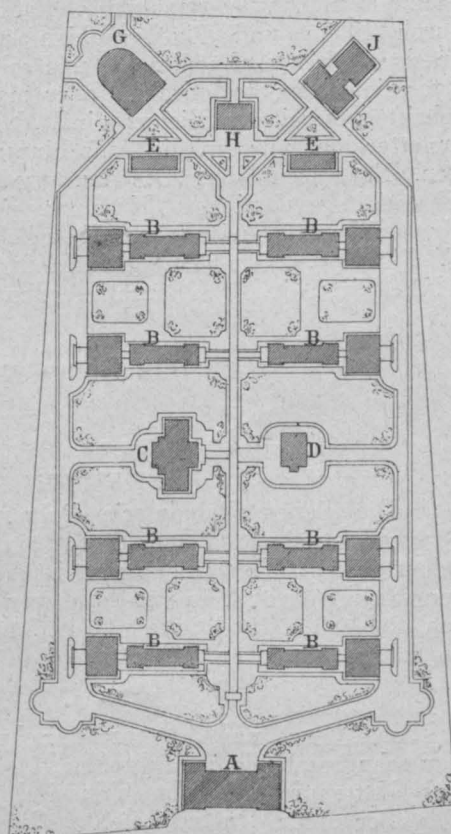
Lageplan des St. Ladislaus-Spitals, Budapest.
